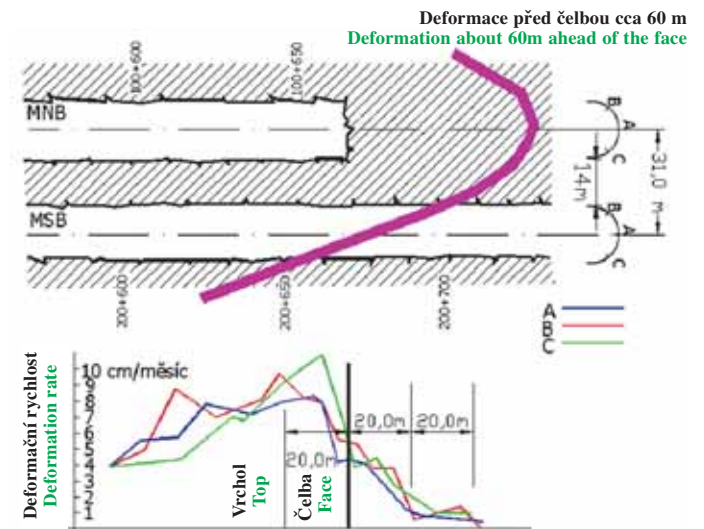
Enormní deformace druhého tunelu způsobeném pozdním provedením spodní klenby
